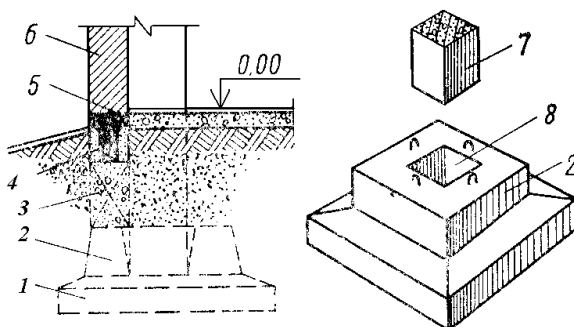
Збірний залізобетонний підколонник склянкового типу:
